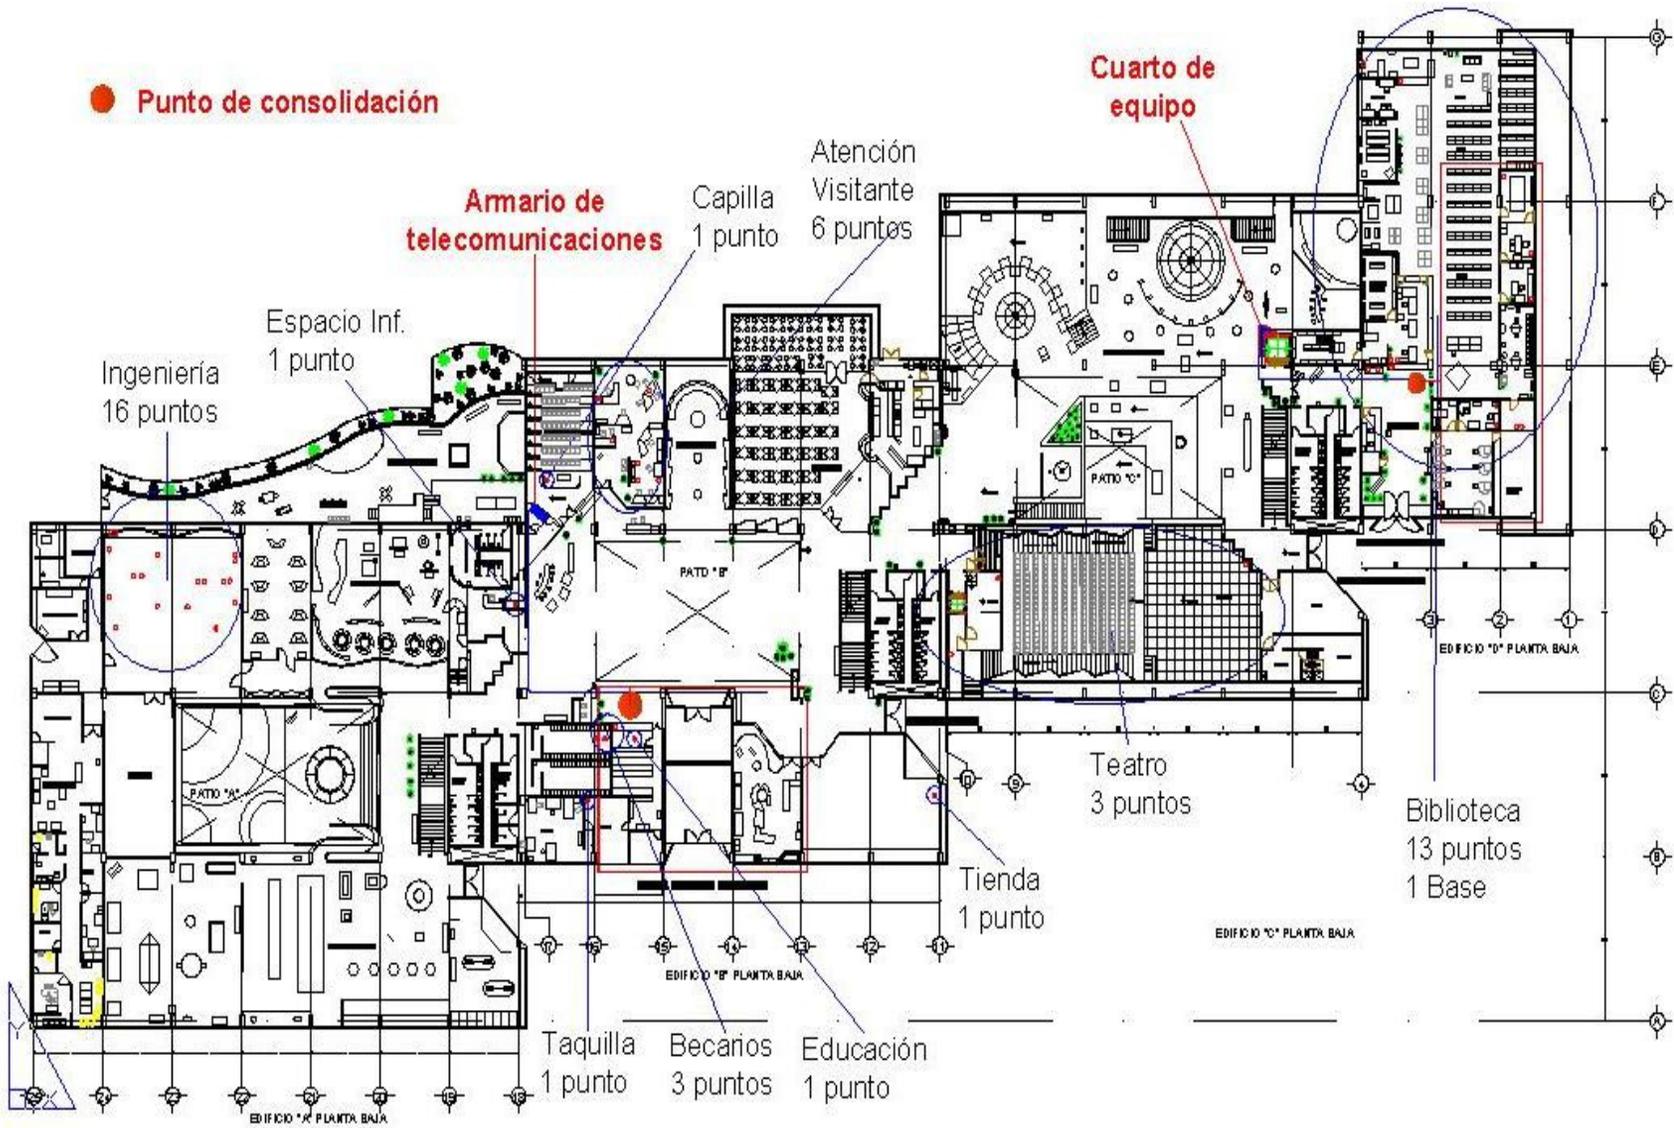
Cableado horizontal en Planta Baja - Universum
